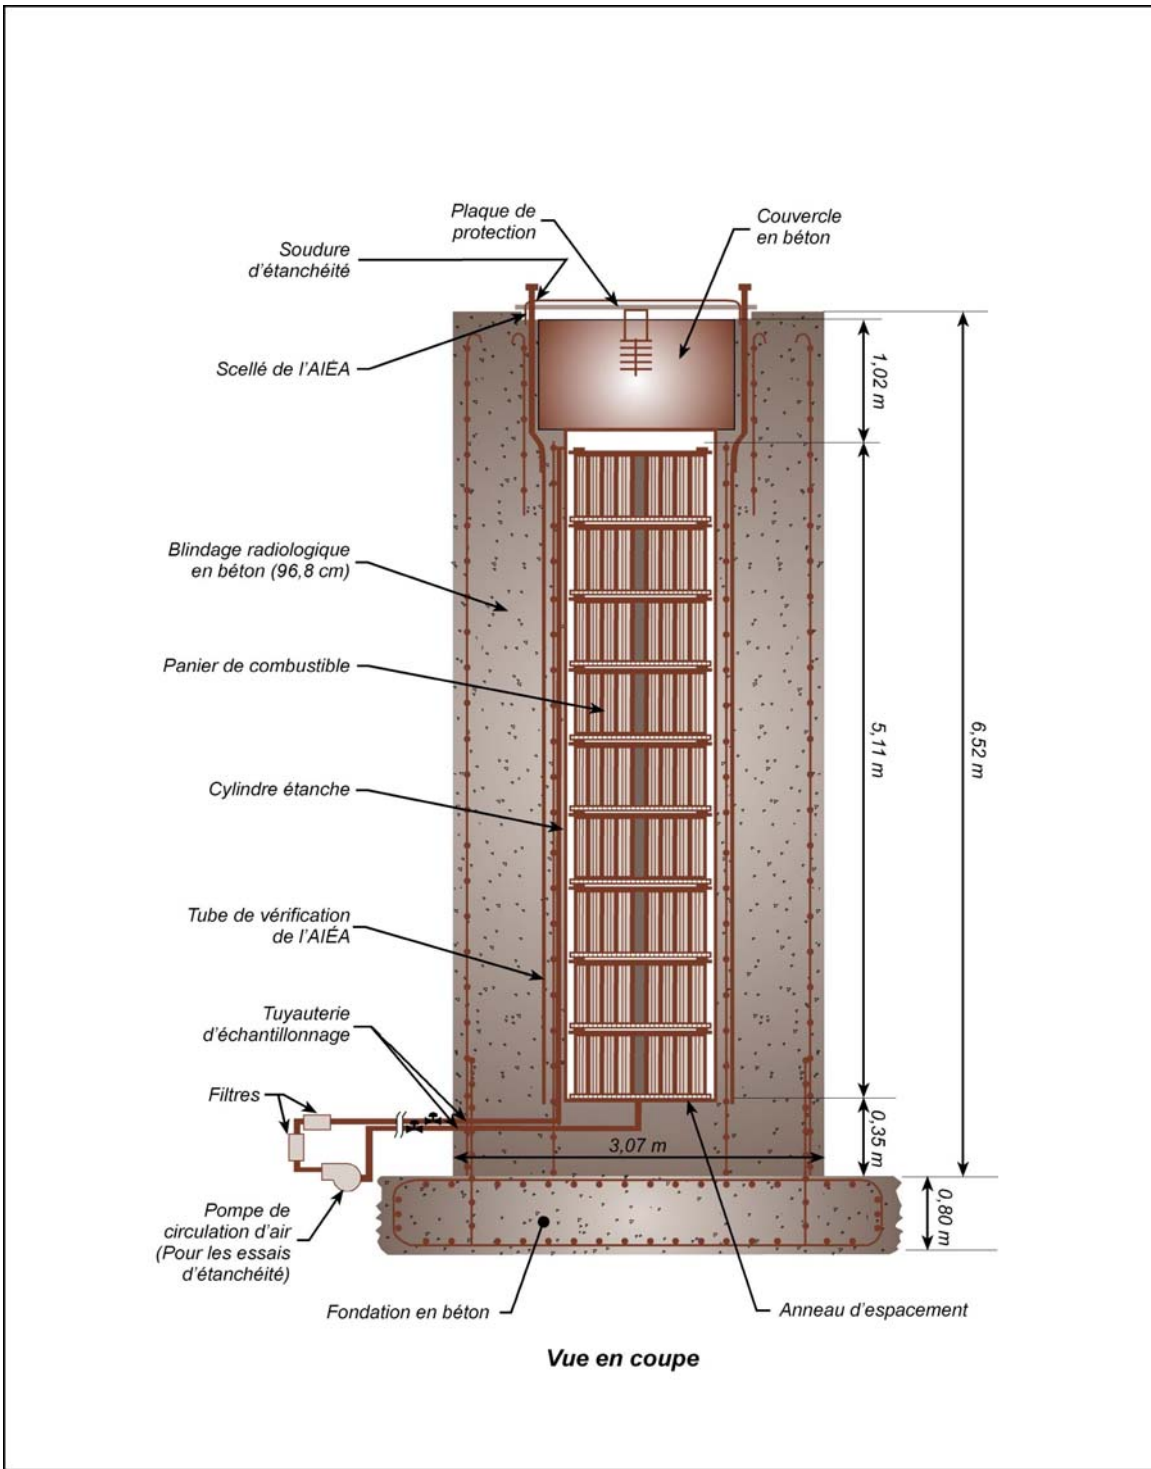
Silo pour le stockage à sec du combustible irradié
